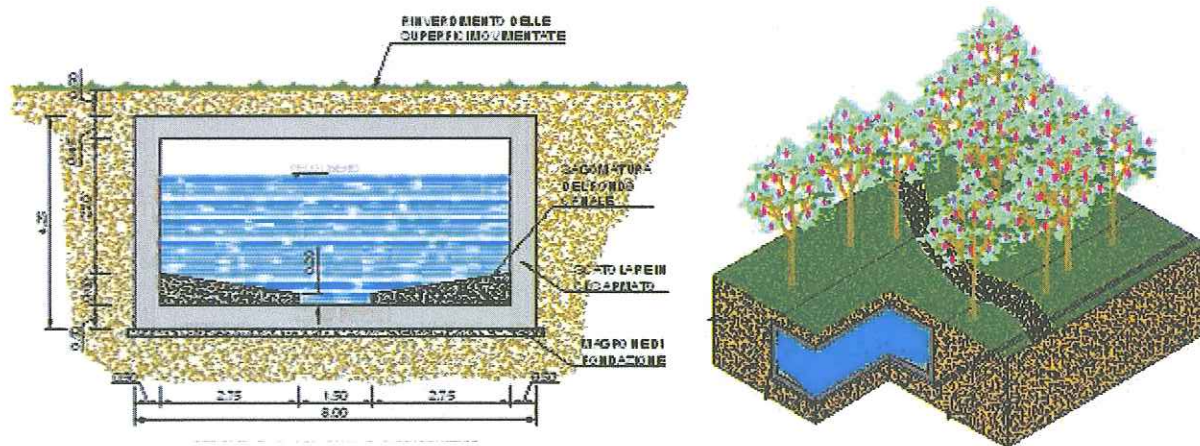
Sezione e spaccato assometrico del canale sedimentatore.
